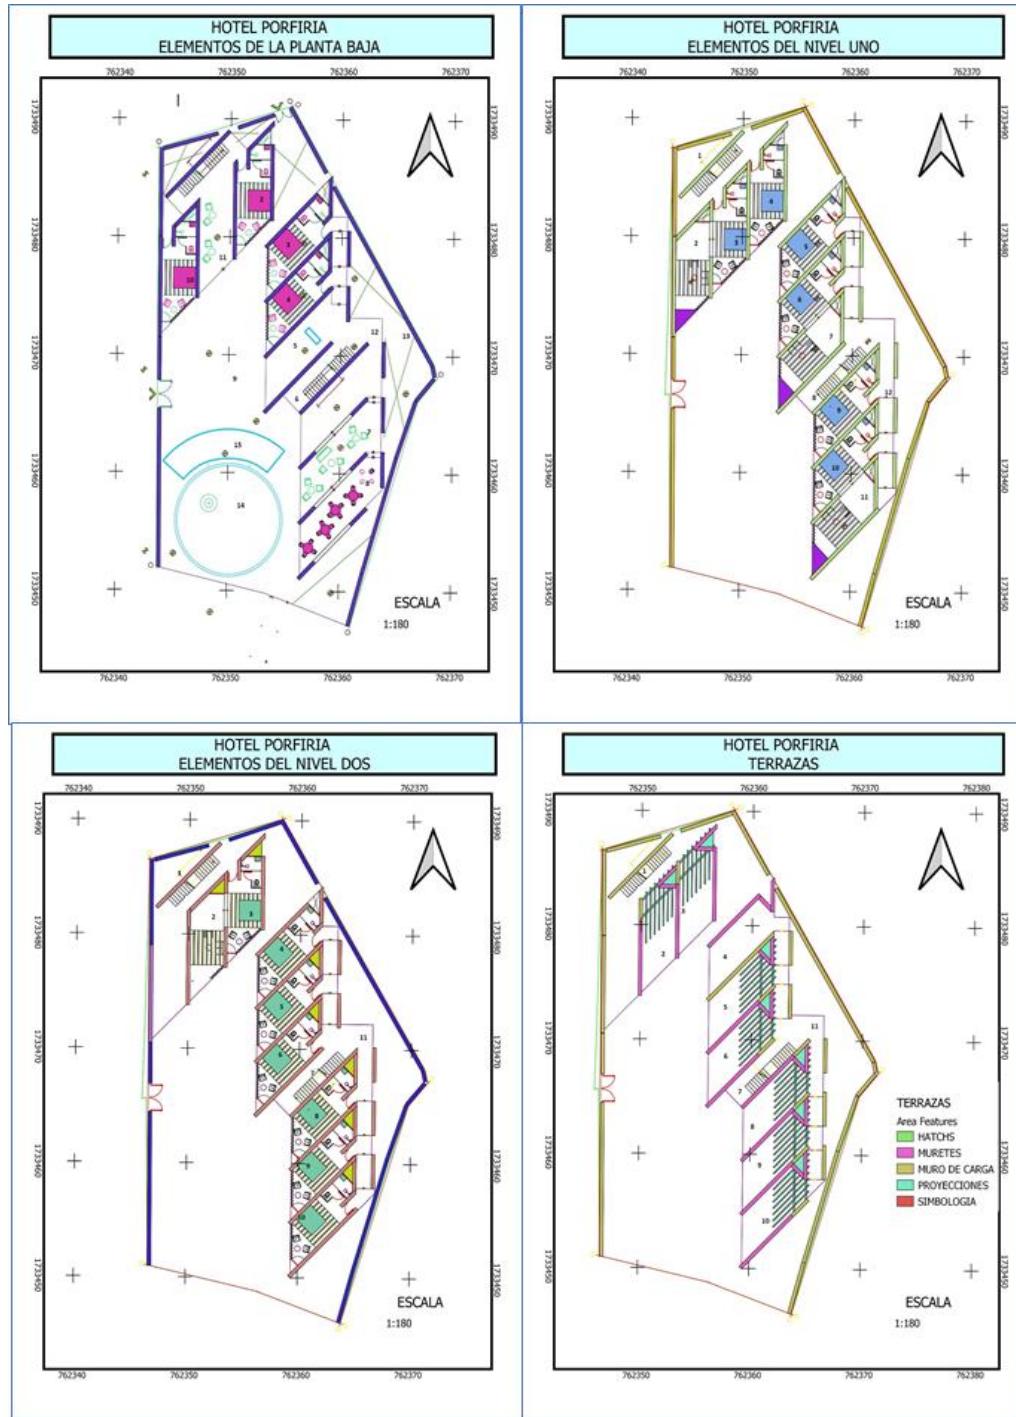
Planta de los elementos proyectados en planta baja nivel uno, dos y terraza
